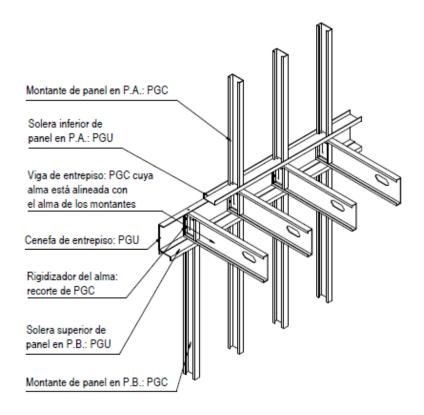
Componentes de un entrepiso modulado correctamente. Fuente: (ConsulSteel, 2014).
